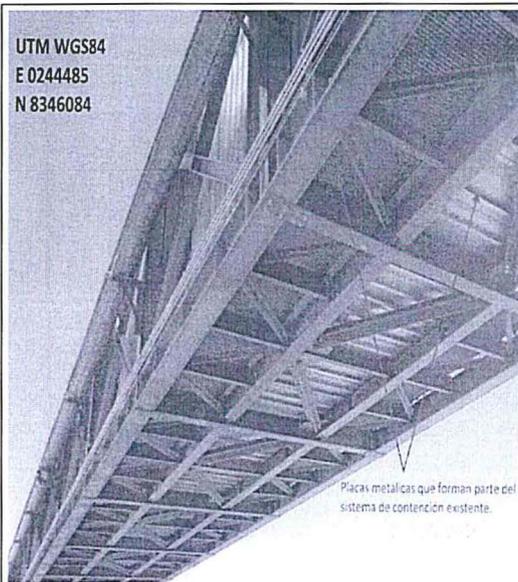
Vista panorámica inferior del puente (se observan las placas metálicas en todo el ancho y largo del puente faja).
